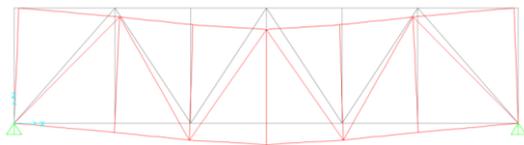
Lentutan pada Jembatan Tipe Pratt Truss
